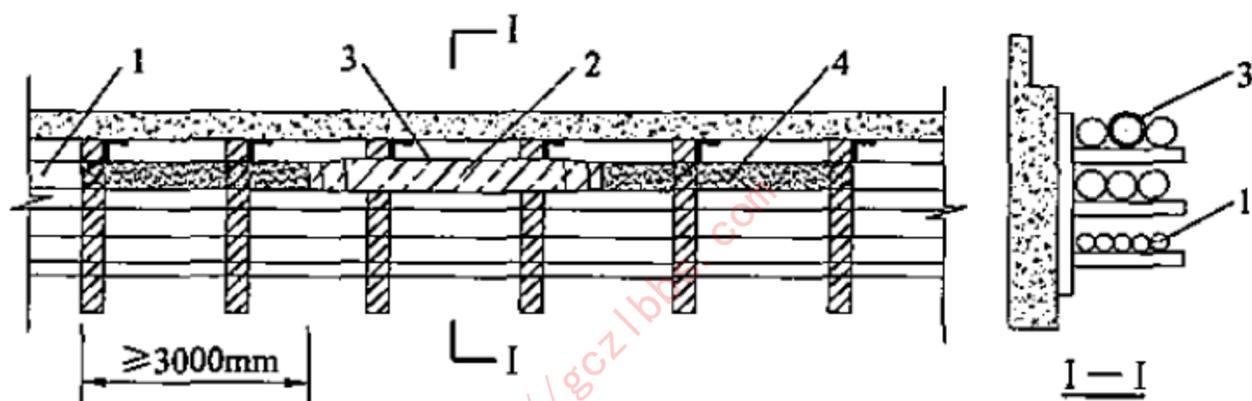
电力电缆中间接头采用电缆用阻燃包带施工示意图
